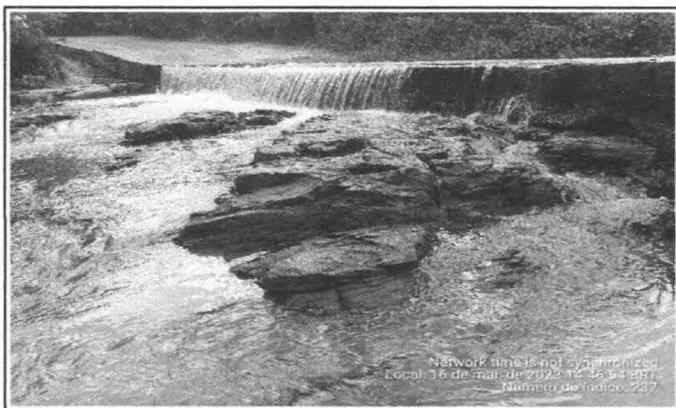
PASSAGEM MOLHADA EXISTENTE
